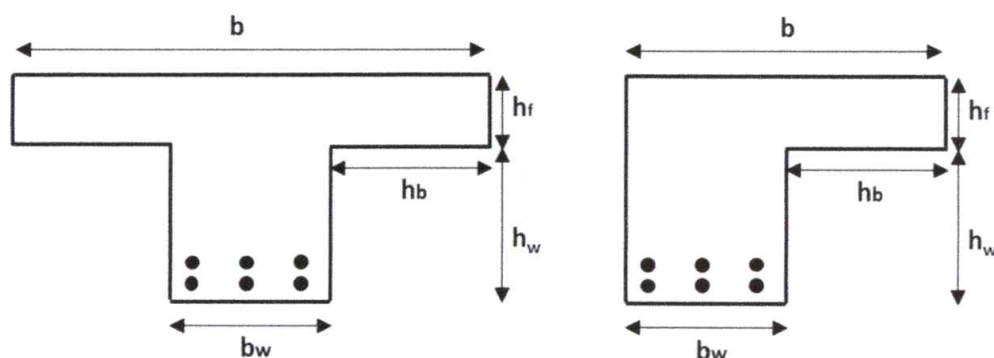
Esquema de dimensiones de vigas interiores (T) y vigas de borde (L).
